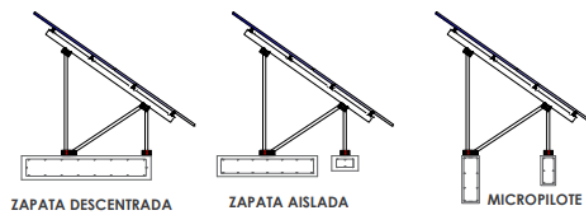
Ejemplos de cimentaciones para la estructura elegida
